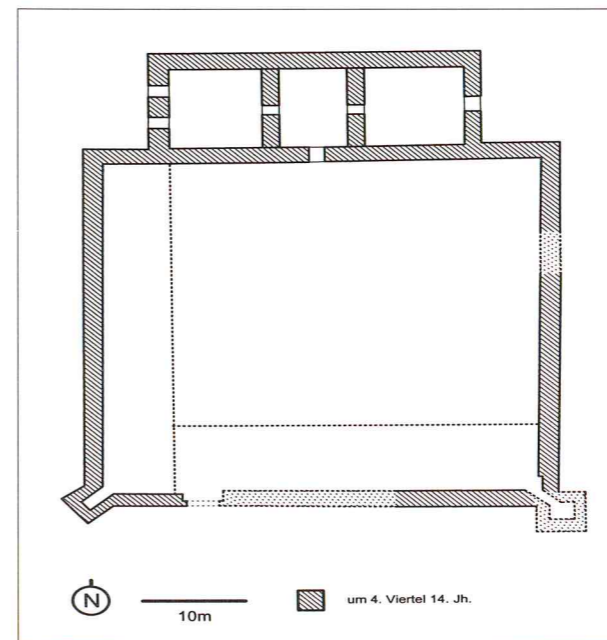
Taplacken. Grundriss der Burg (Rekonstruktion des mittelalterlichen Zustands). (Zeichnung: C. Herrmann)
